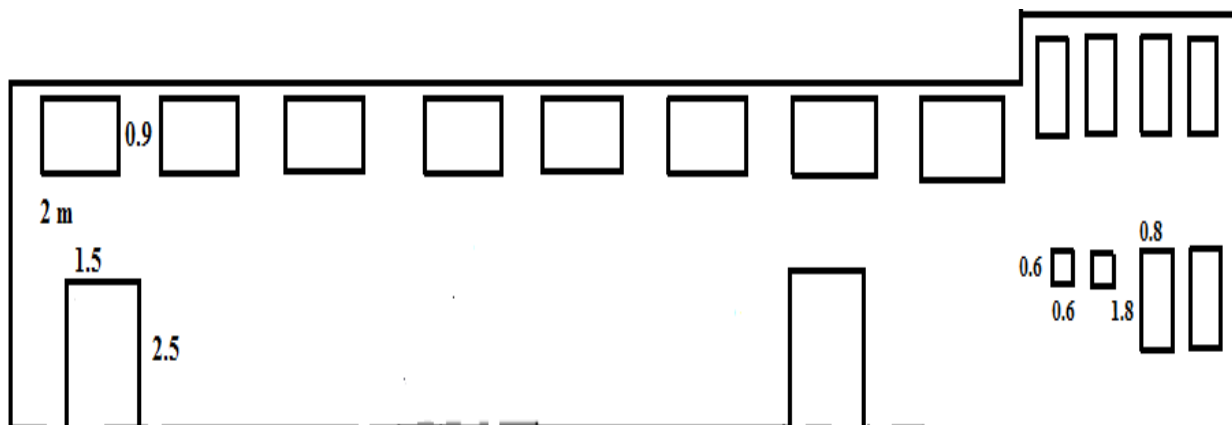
Surfaces des ouvertures sur la façade latérale gauche.
